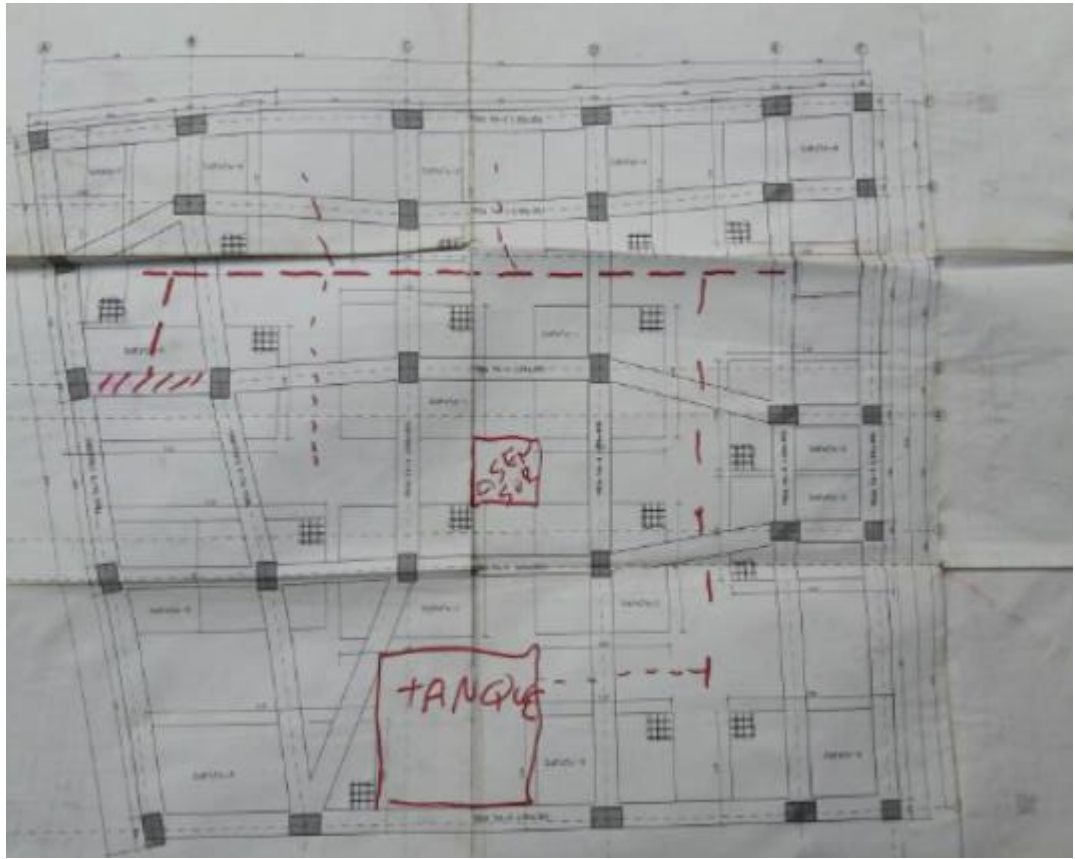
Distribución de Vigas y Zapatas Edificio Limaruz. Fuente: Camargo Construcciones.
